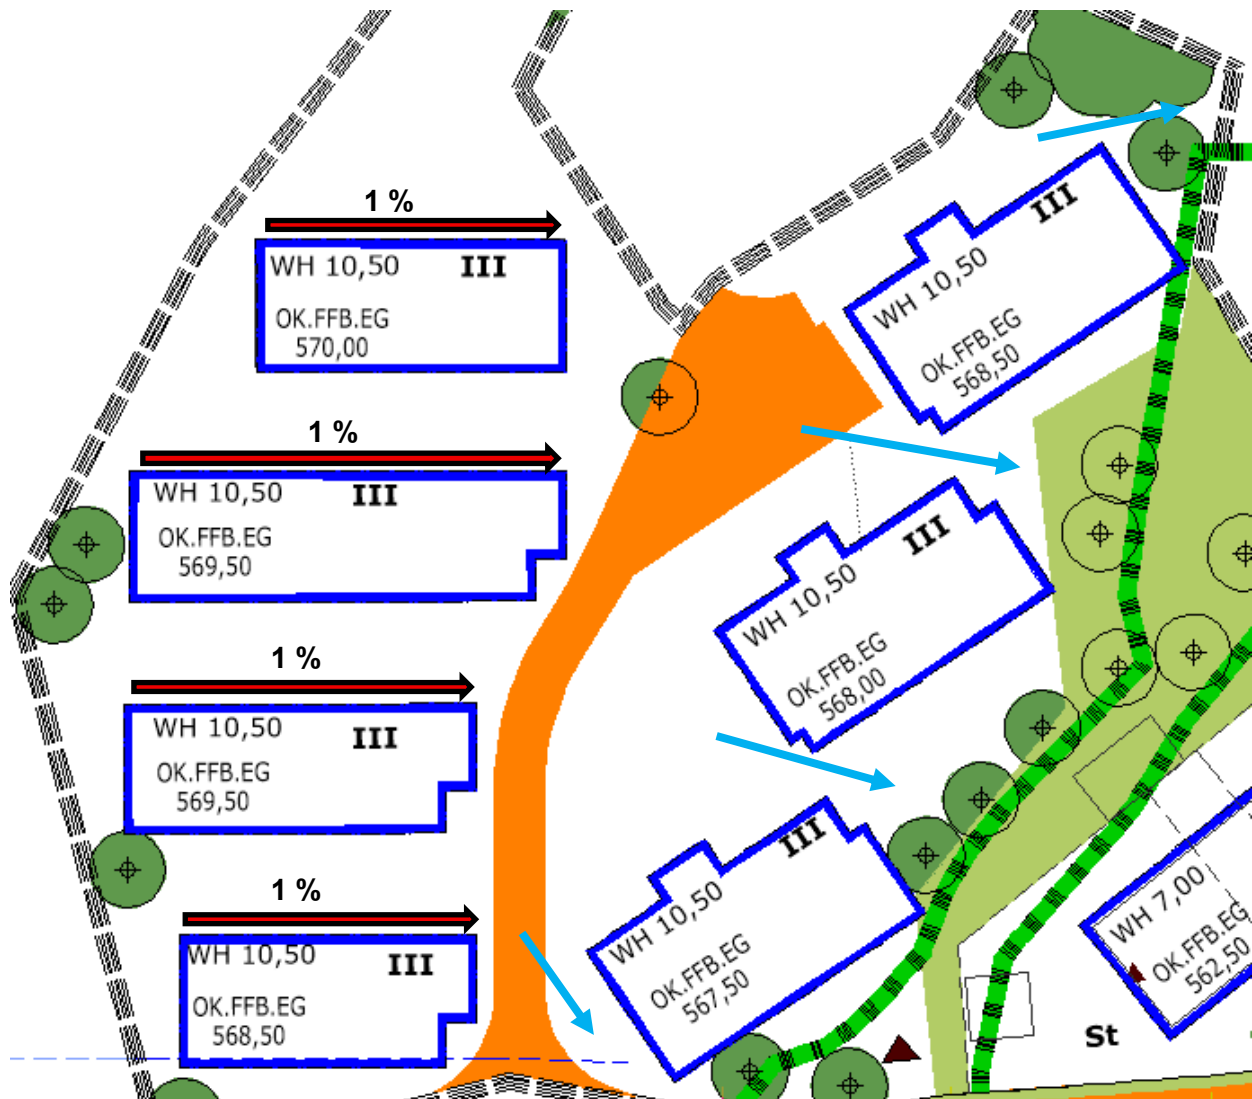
Schutzmaßnahmen im westlichen Bereich des Bebauungsplans „Stangerötz“ (rot: Geländemodellierung; blaue Pfeile: Durchleitungsbereiche)
